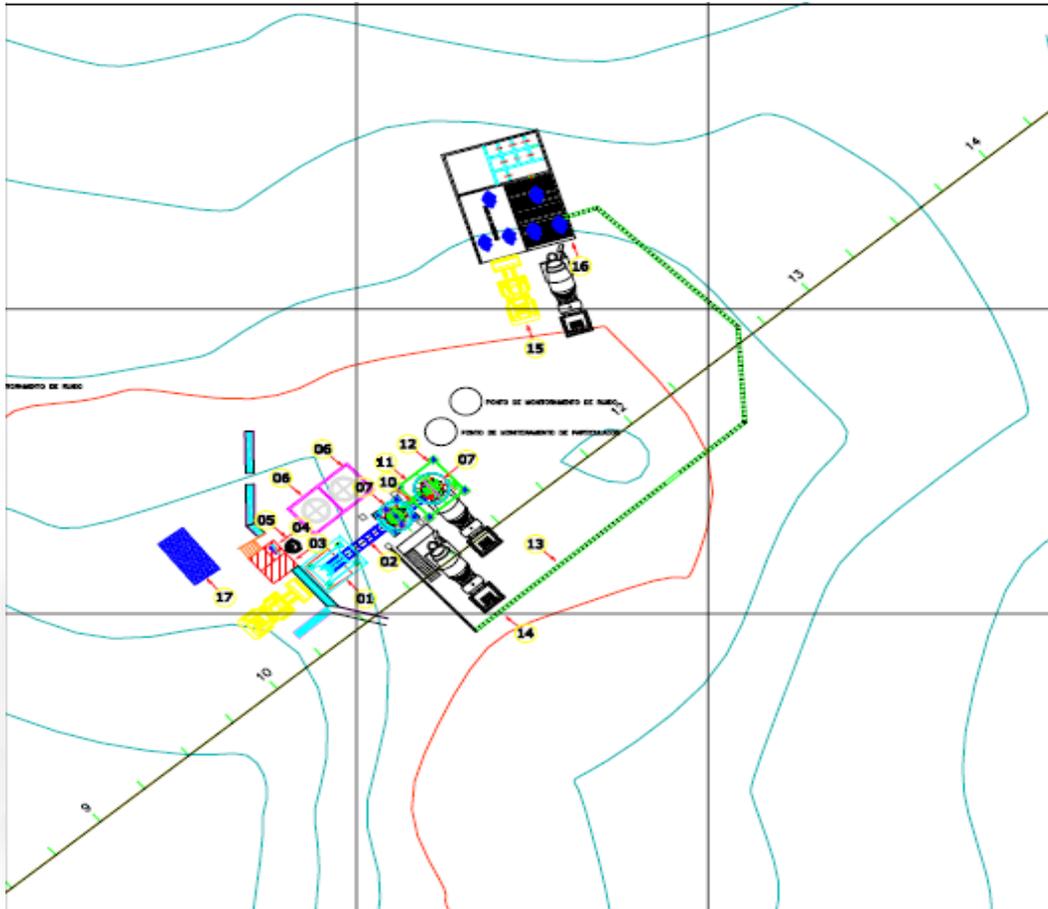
Lay-out da Central de CCR (Concreto Compactado a Rolo)
